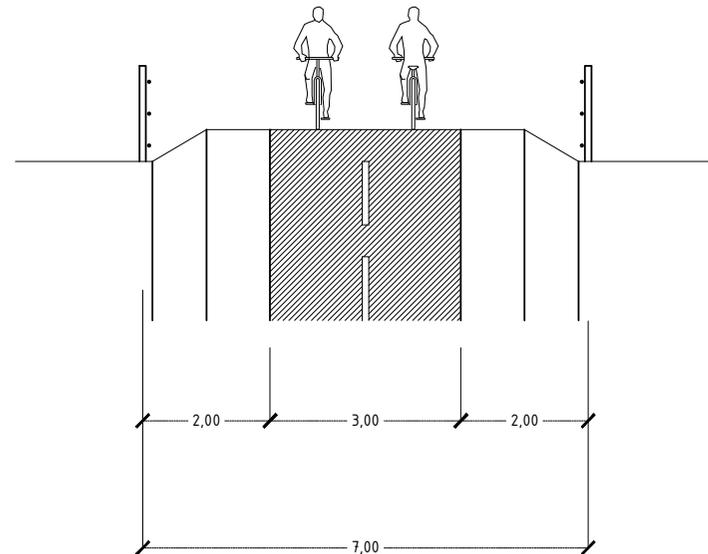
Sección faja de 7 metros de ancho, Elaboración propia.
